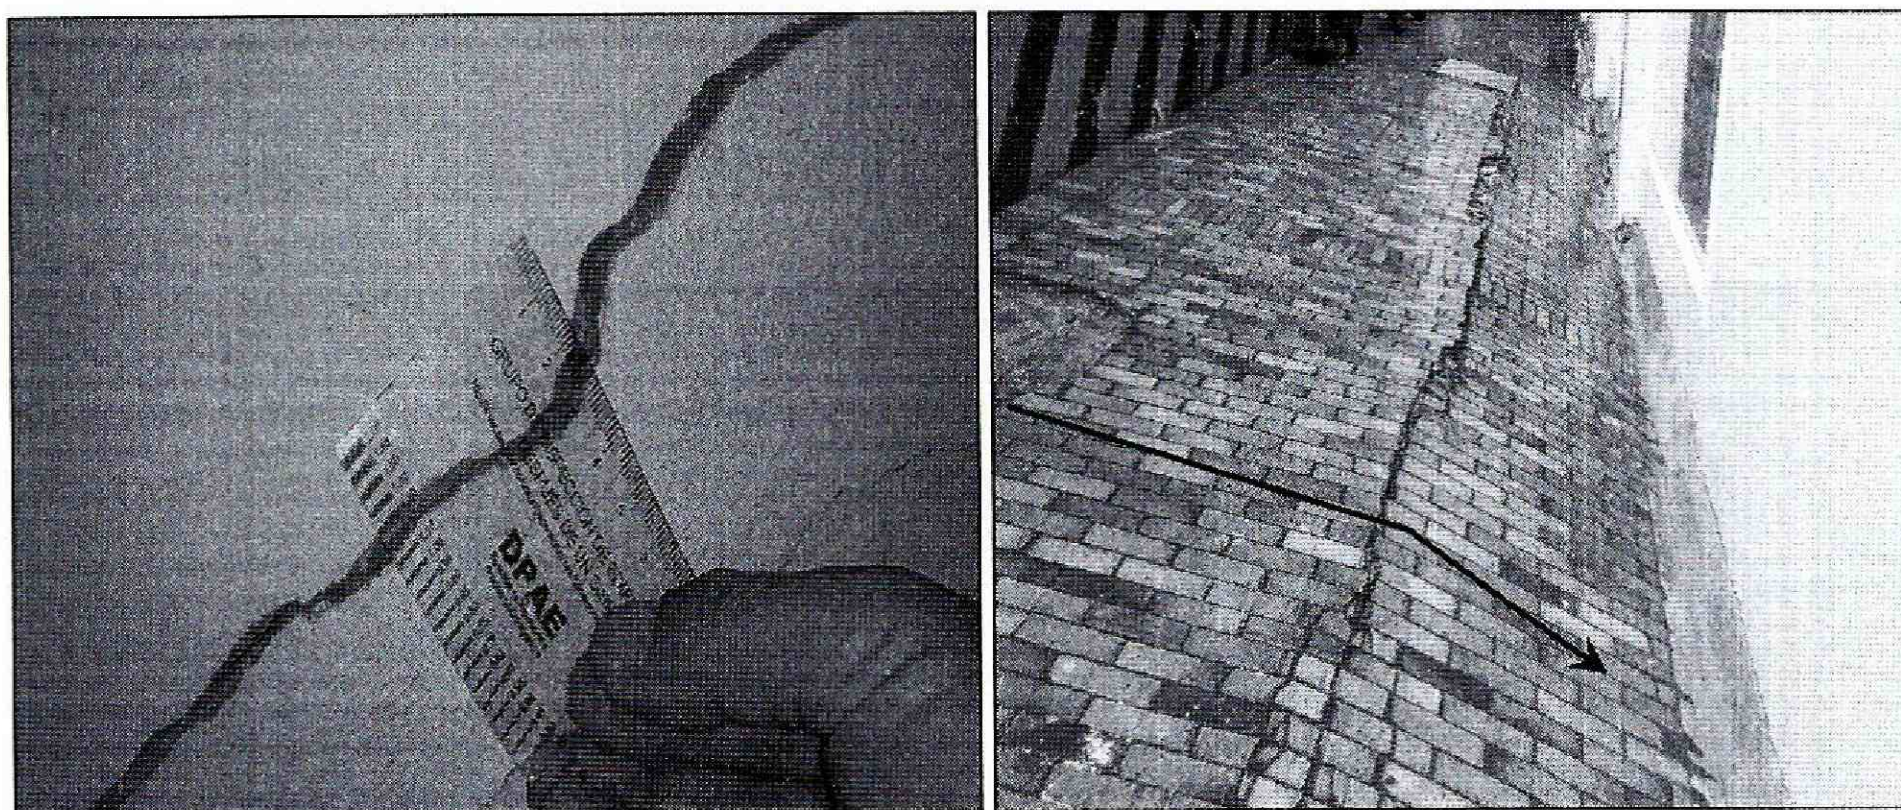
, 18 y 19. Vista de las lesiones evidenciadas en el edificio de la Calle 85 No. 12-10, Grietas de tendencia vertical en muro de fachada y grietas de tendencia longitudinal en placa de entrepiso del primer nivel
